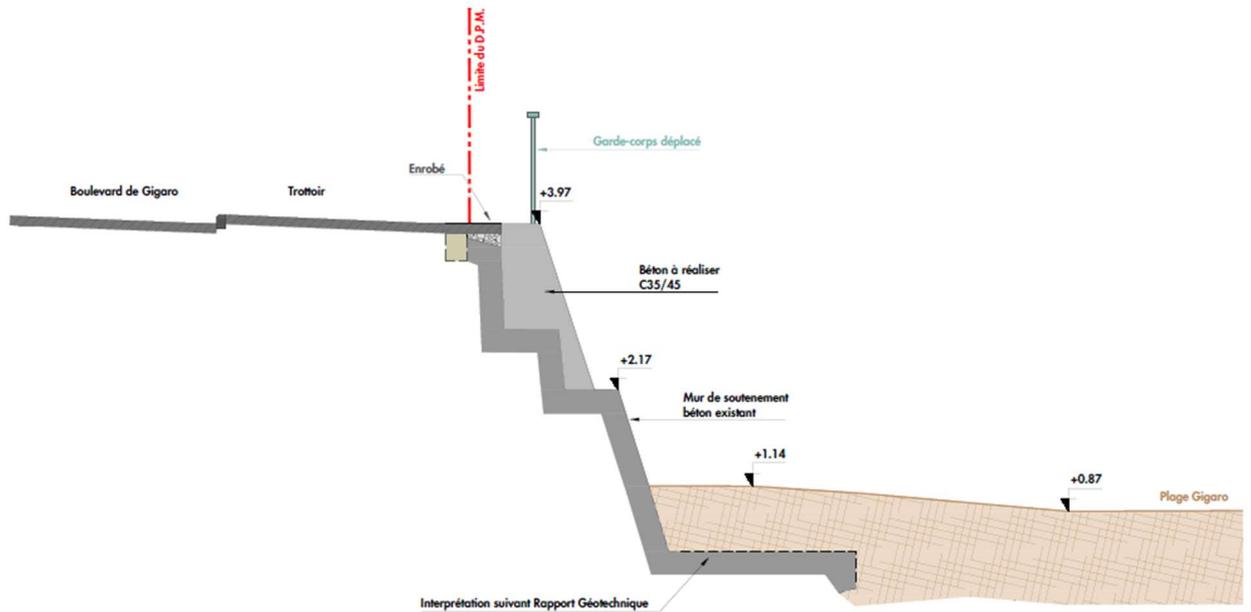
Zone 1 / Coupe type 1 (mur projet sur existant)
